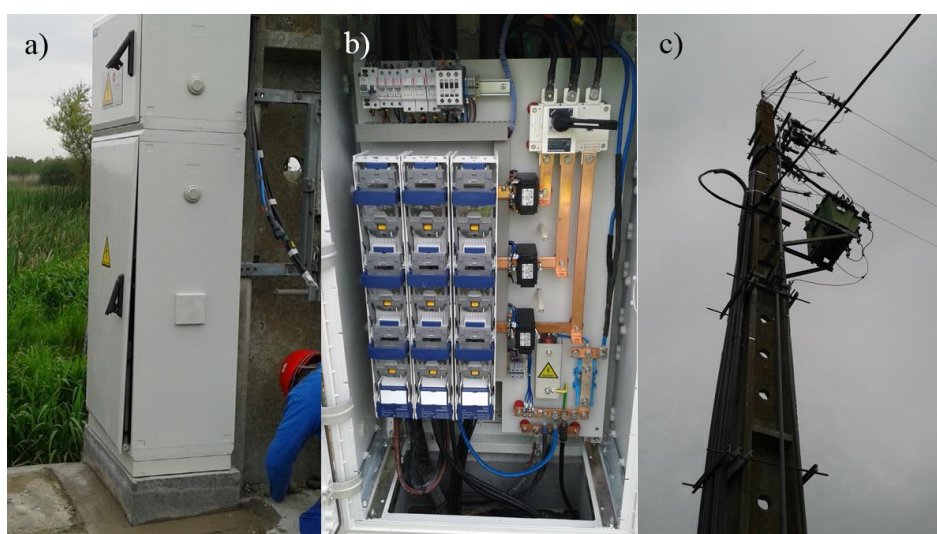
a) Retoques finais de acabamento de construção civil, b) interior do QGBT, c) tubos de proteção dos condutores do PT.
